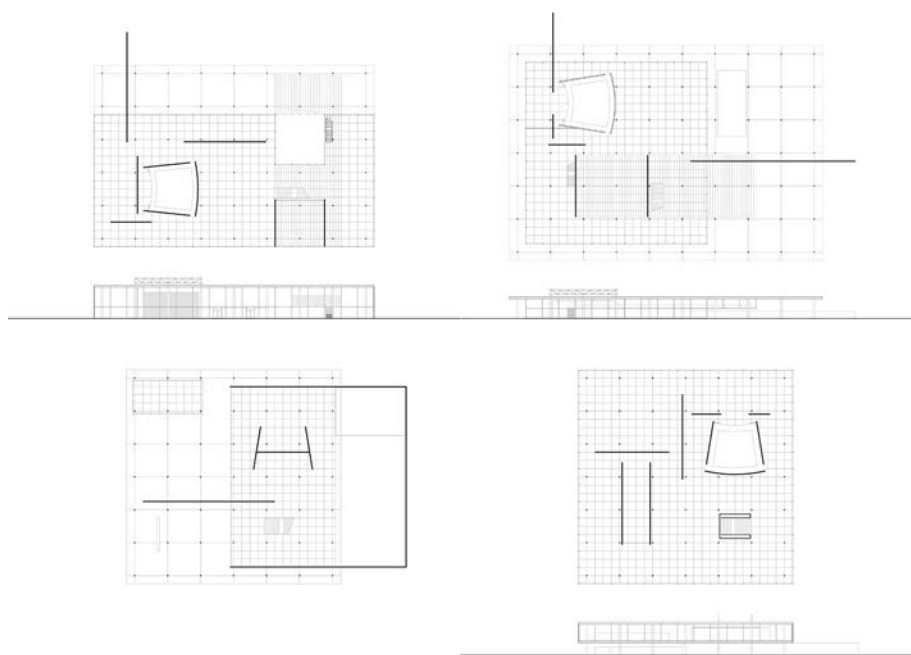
Vera Jansone, "An Arts Club", 1952, detalle en planta y sección. Redibujado por las autoras. Izq. Sección | Drcha. Planta
